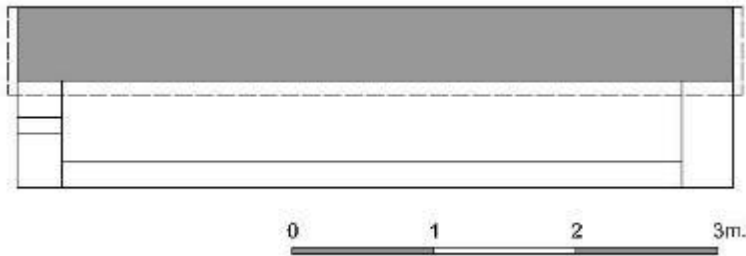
Fethiye Mahallesi Çeşmesi II Plan (Çizim: F. CANYURT)
